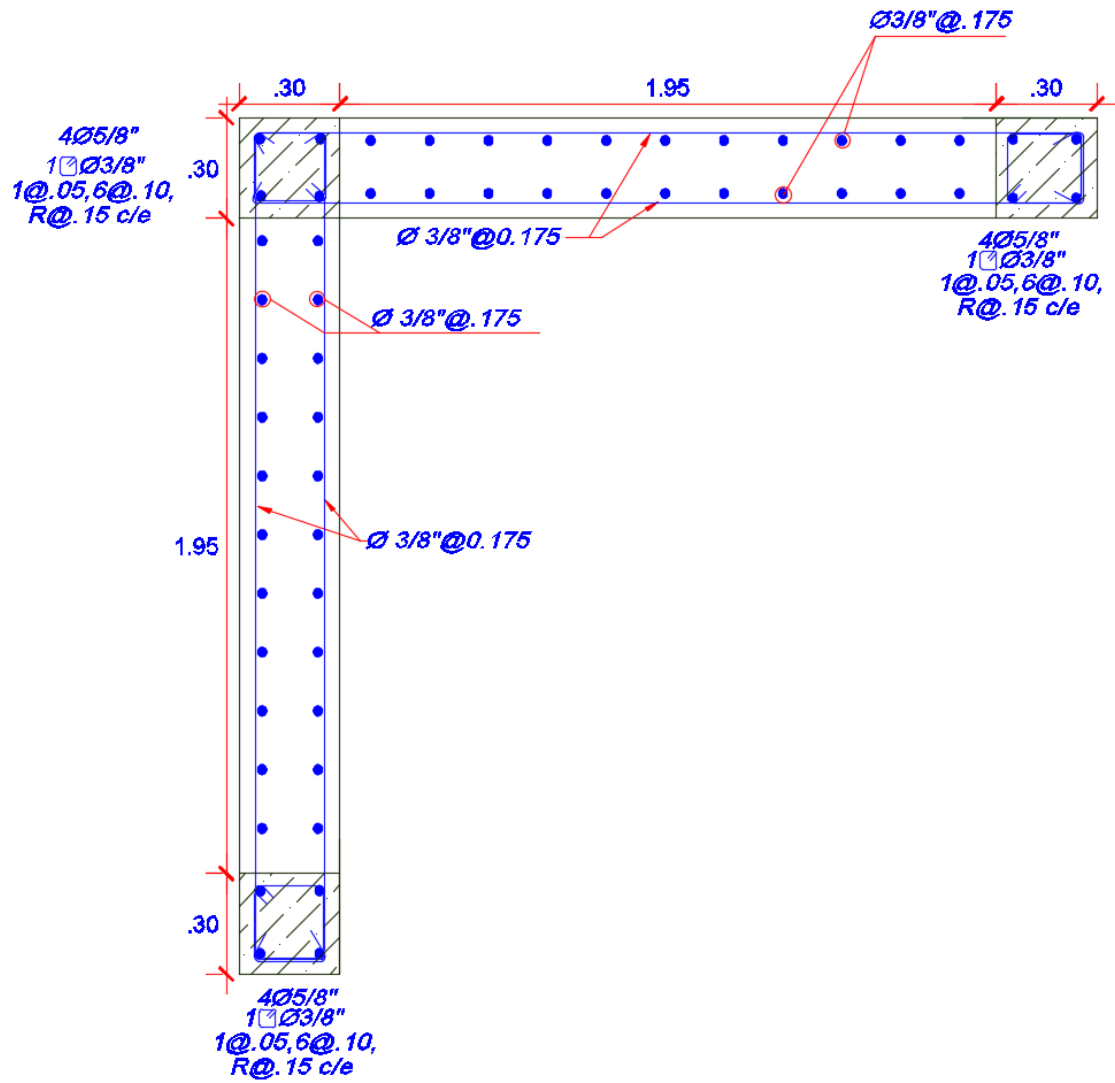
Plano final de la placa PL-01 (3-11 Piso)
